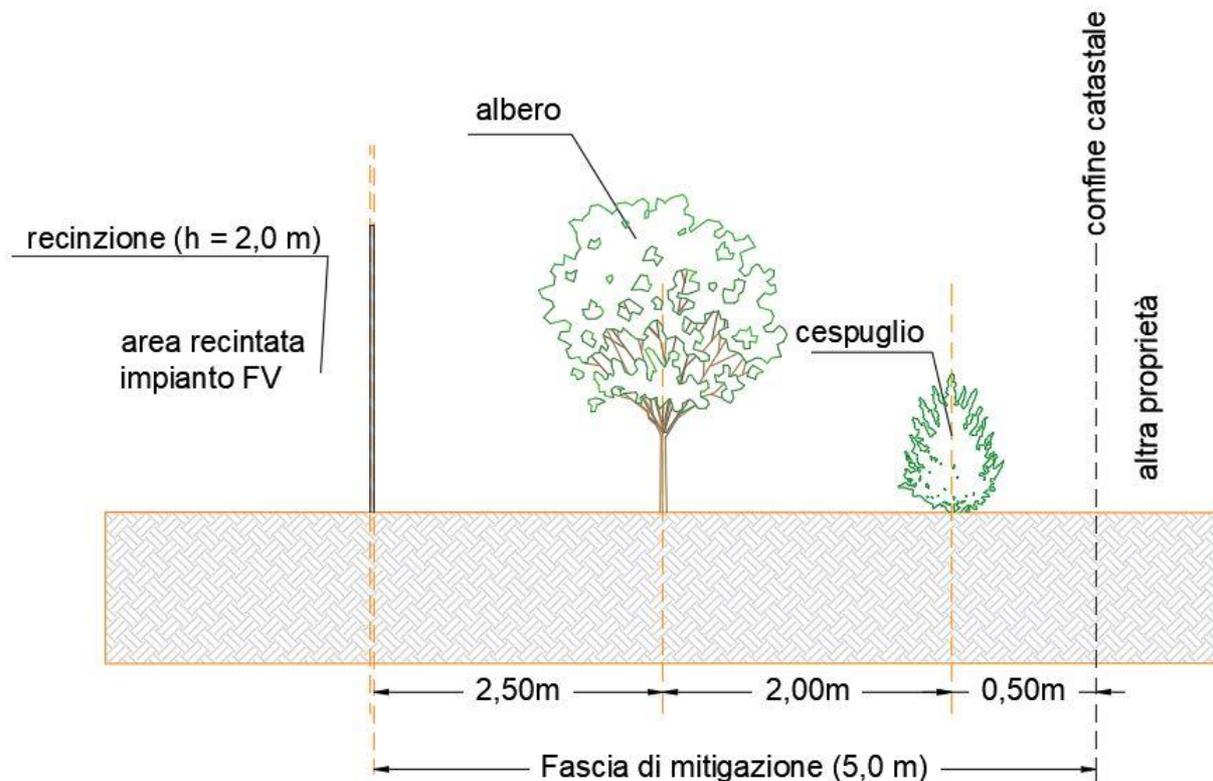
Stralcio di sezione dell'area perimetrale dell'impianto.
